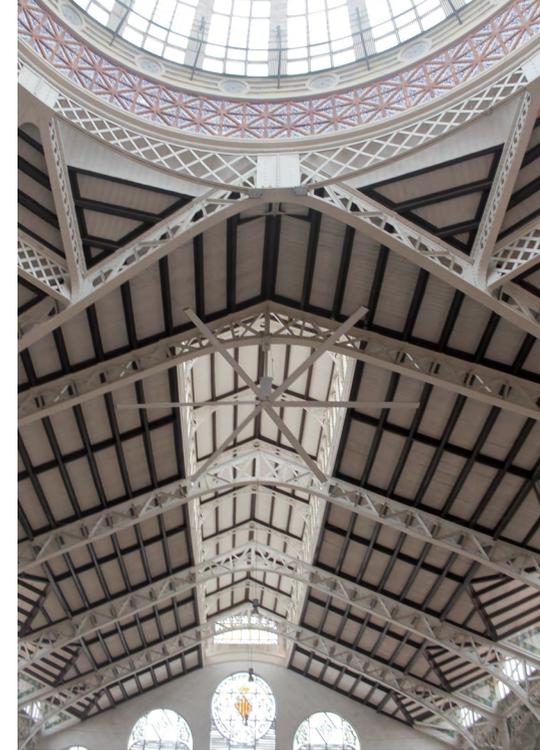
Fotografía de la cubierta: entrada de luz (Imagen propia)
